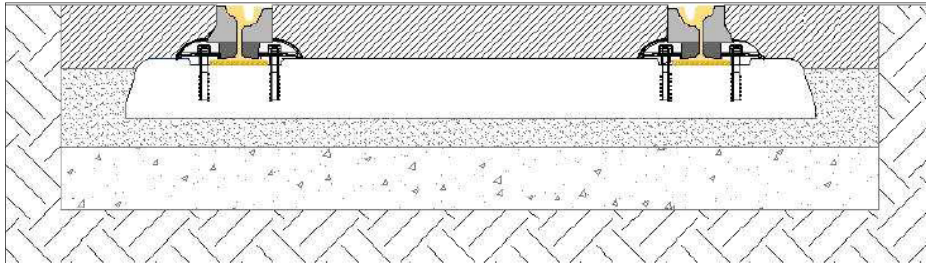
Vía con carril embebido de primera generación. Fuente: [24]
